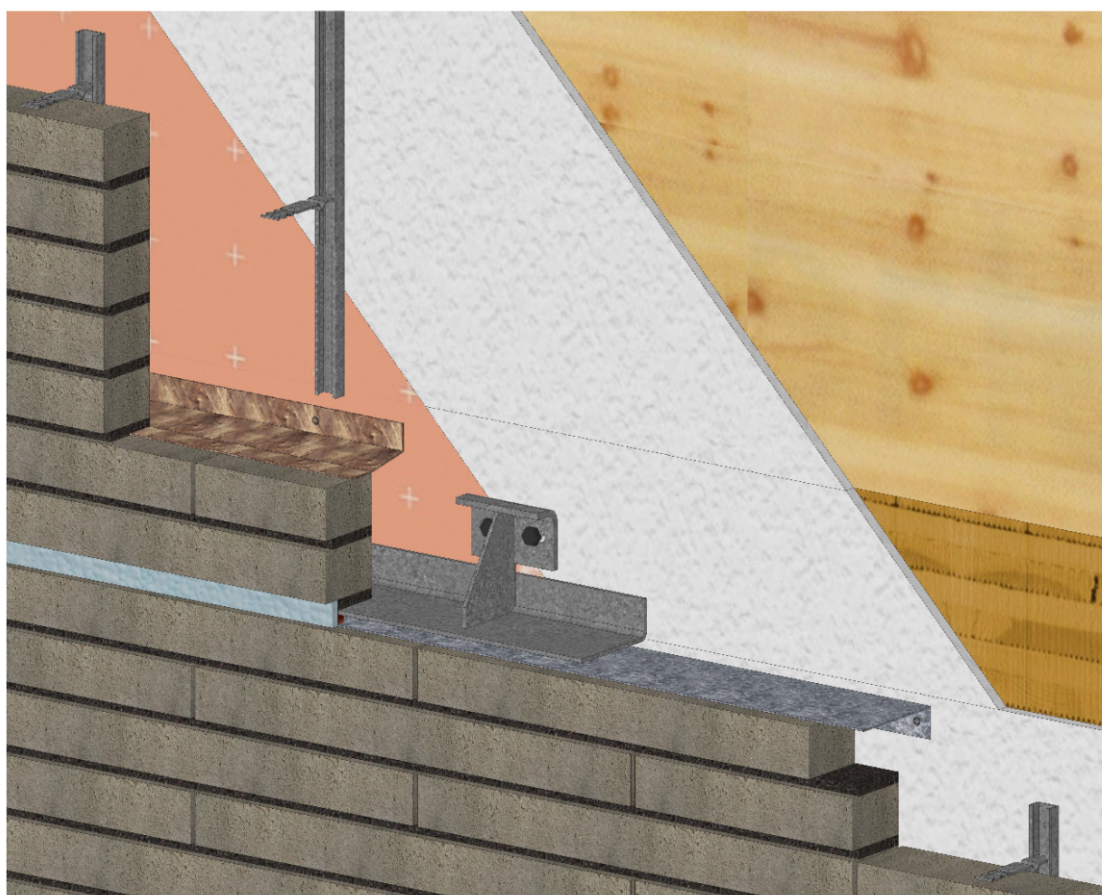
Cas d'un mur porteur en panneau structural massif bois (p.ex. CLT) – Ecran thermique de type plaque
